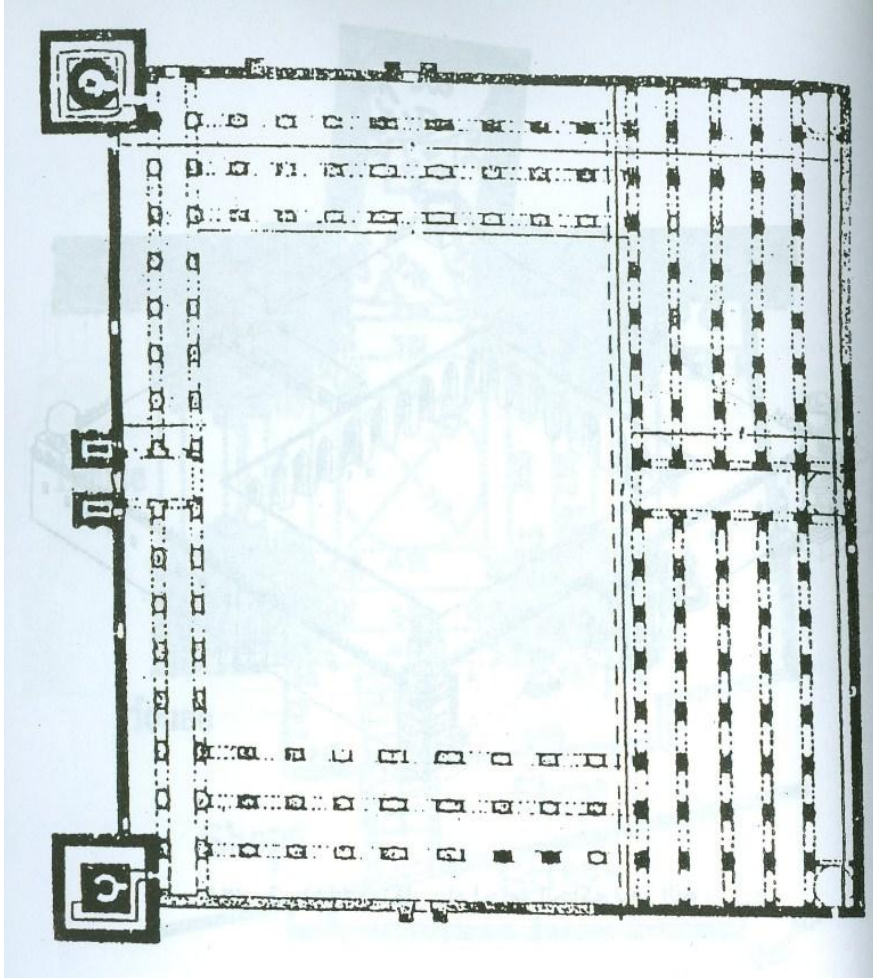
/ج): مسقط أفقي لجامع أبي دلف. عن: كريسويل
